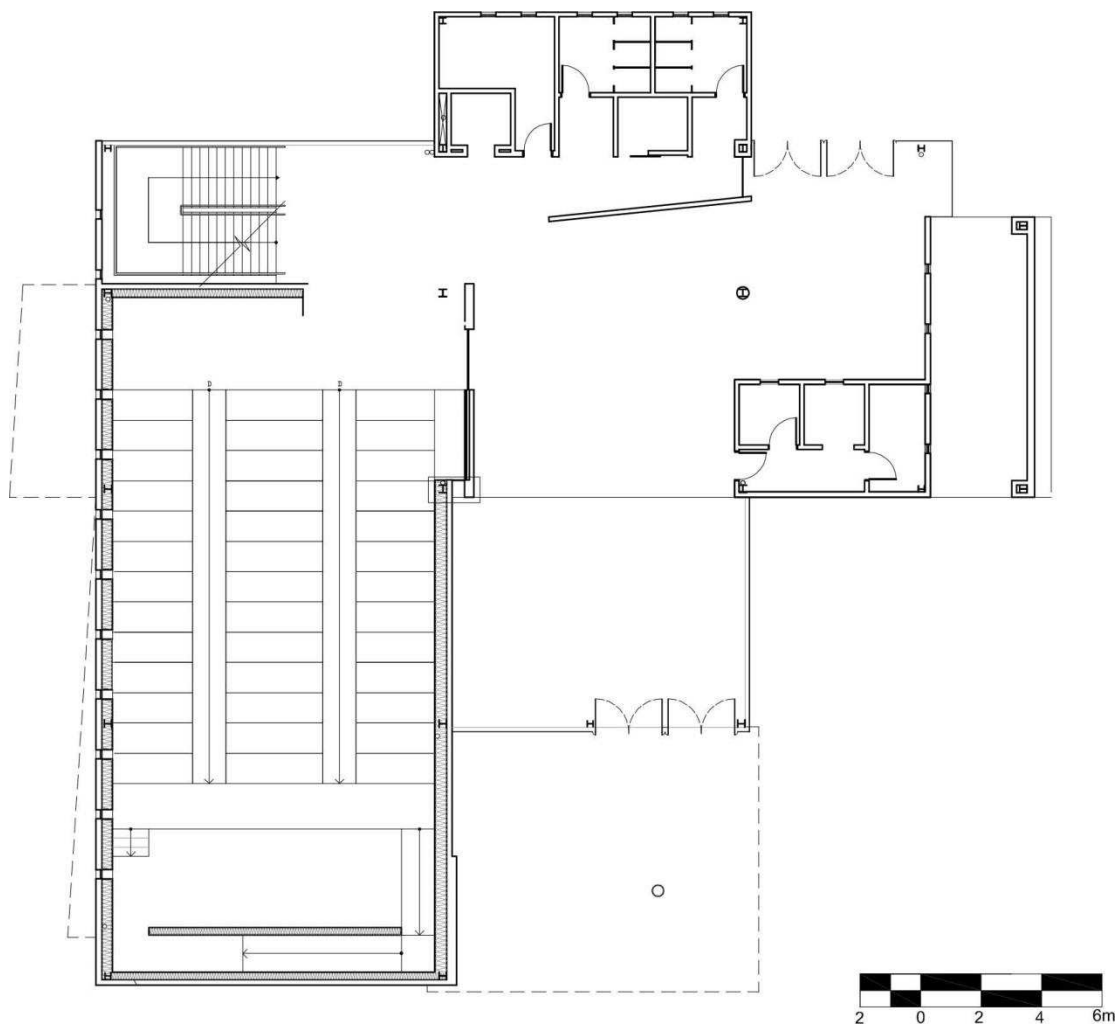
Planta do pavimento térreo do Edifício da CEAD.
